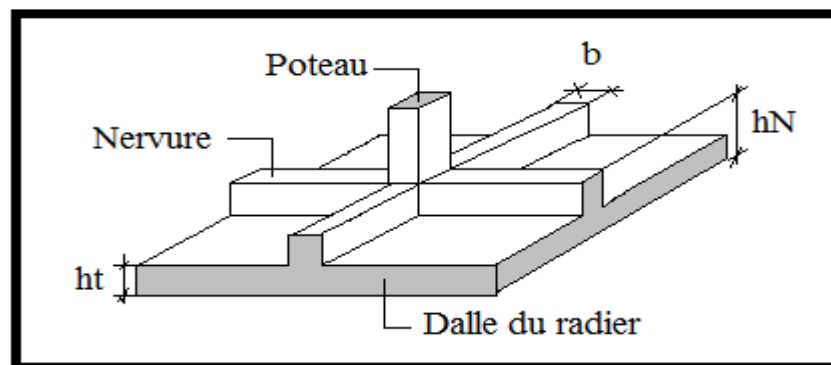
Disposition des nervures par rapport au radier et aux poteaux
